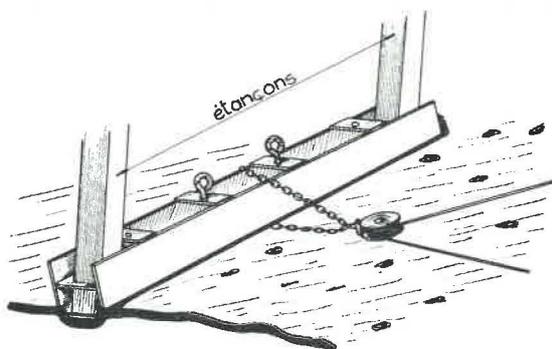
Remblayage par scraper. Poutrelle d'amarrage de la poulie de tête. Vue en perspective de l'ensemble.
